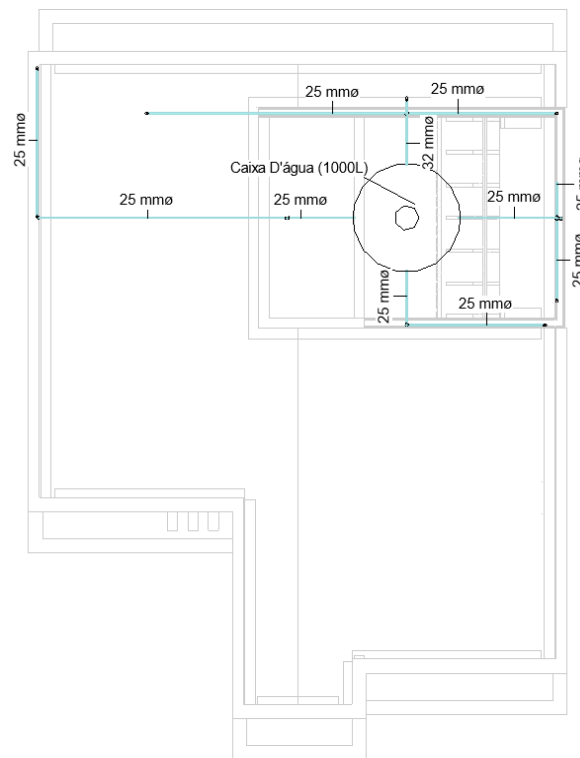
Planta Baixa do reservatório – Pavimento Superior
